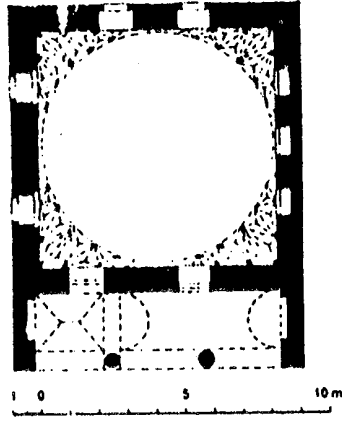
مسقط أفقي لمسجد الحيدرية بقزوین (عن : Pope)
